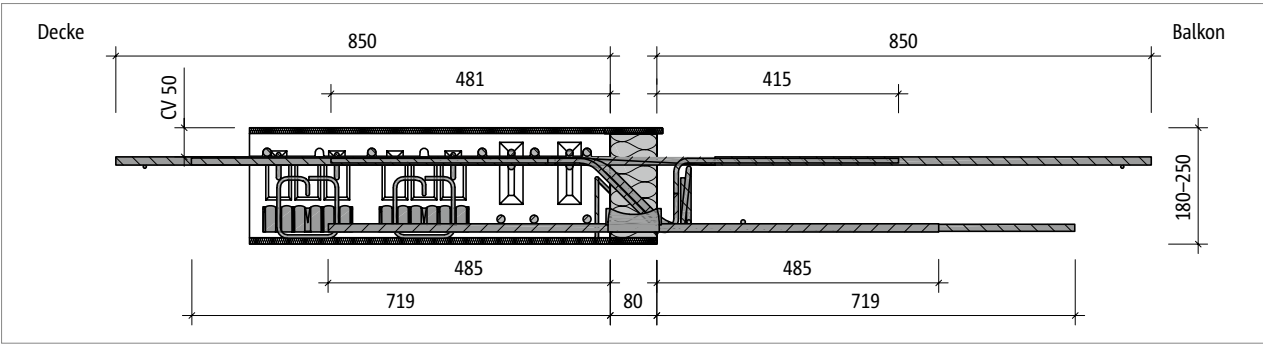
Schöck Isokorb® T Typ C-M2: Produktschnitt
